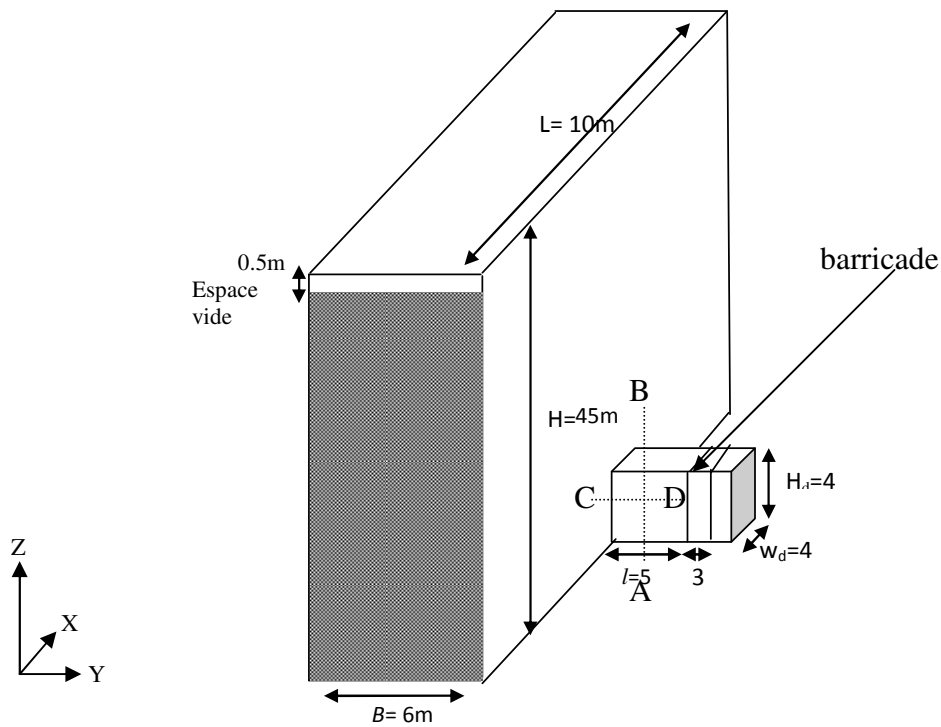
Schéma d'un chantier minier souterrain remblayé avec une galerie d'accès et une barricade en roche stérile (sans échelle).
